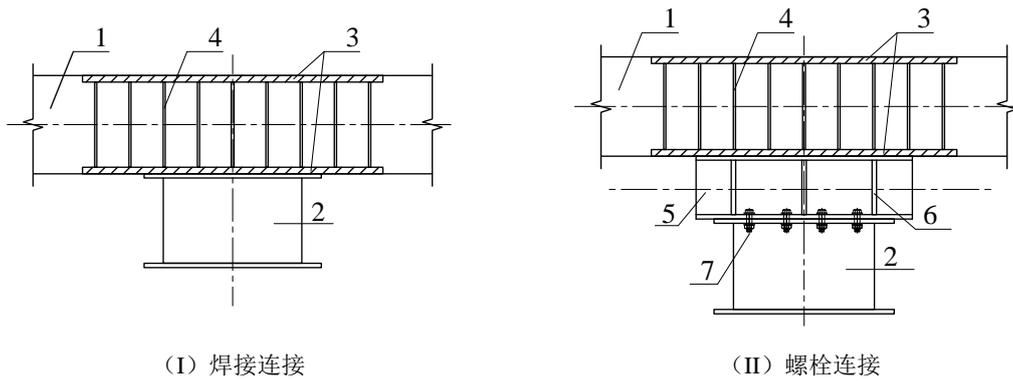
墙式金属阻尼器与现浇混凝土结构梁的支撑型连接构造
